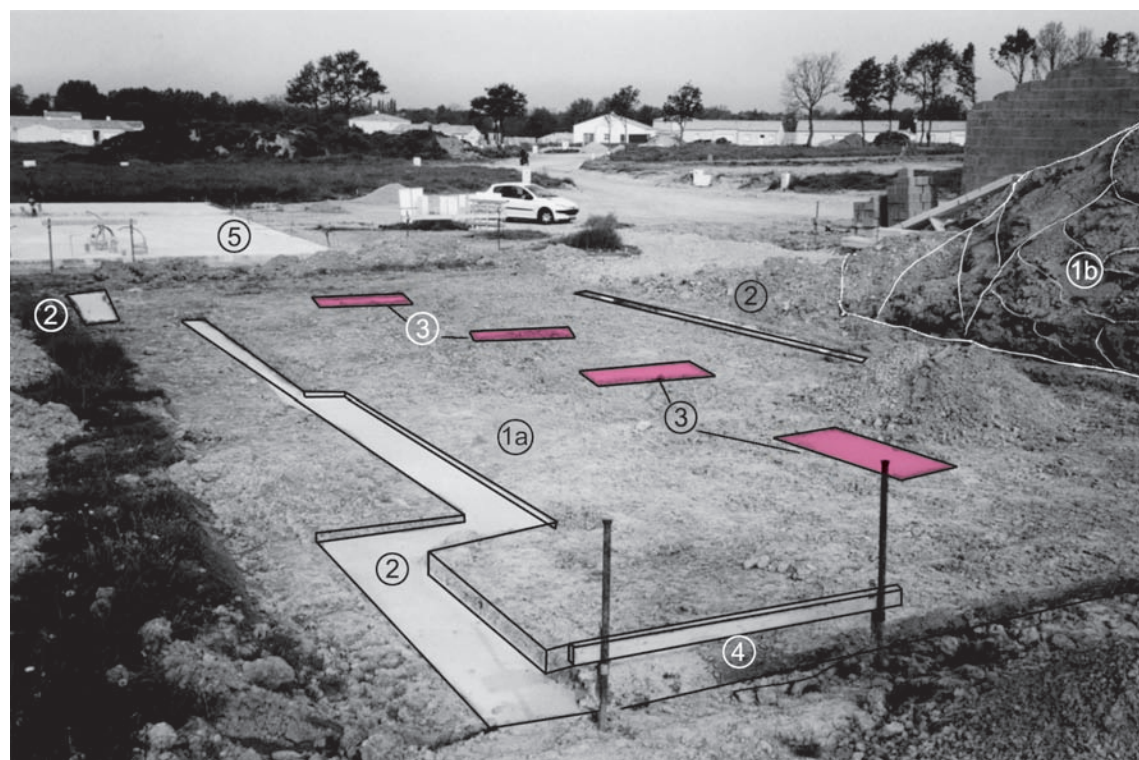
Plan schématique des murs de soubassement et des plots bétonnés de support de dalle BA
